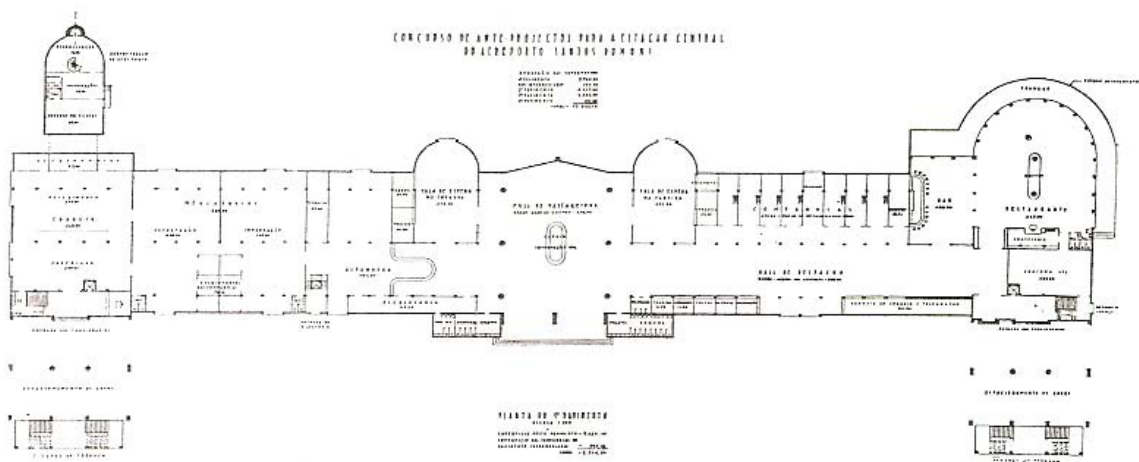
Anteprojeto de Angelo Bruhns - planta baixa do pavimento térreo.
